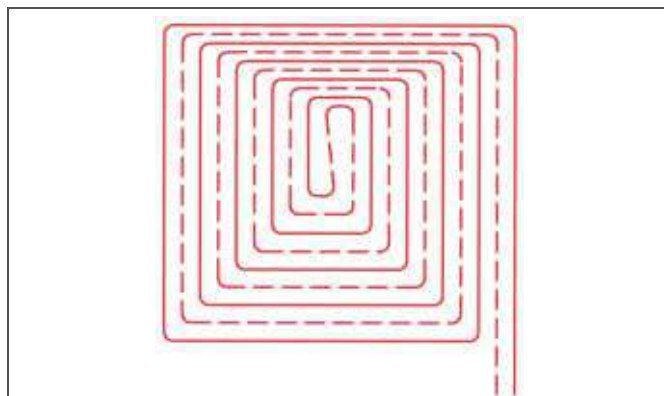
Способ укладки «улитка» с более плотной укладкой в граничной зоне
